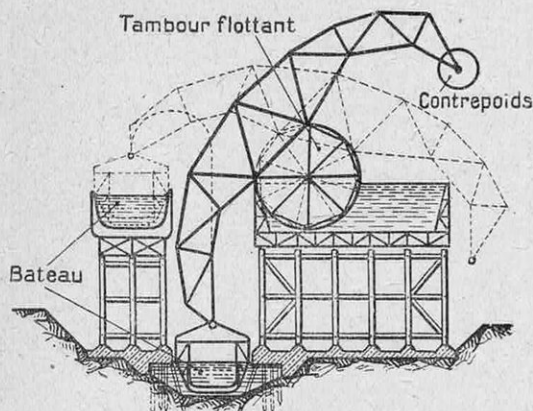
DANS CE PROJET, LE BASSIN SOUTENANT LE BATEAU EST SOULEVÉ AU MOYEN D'UN BRAS PIVOTANT AUTOUR D'UN TAMBOUR FLOTTANT
